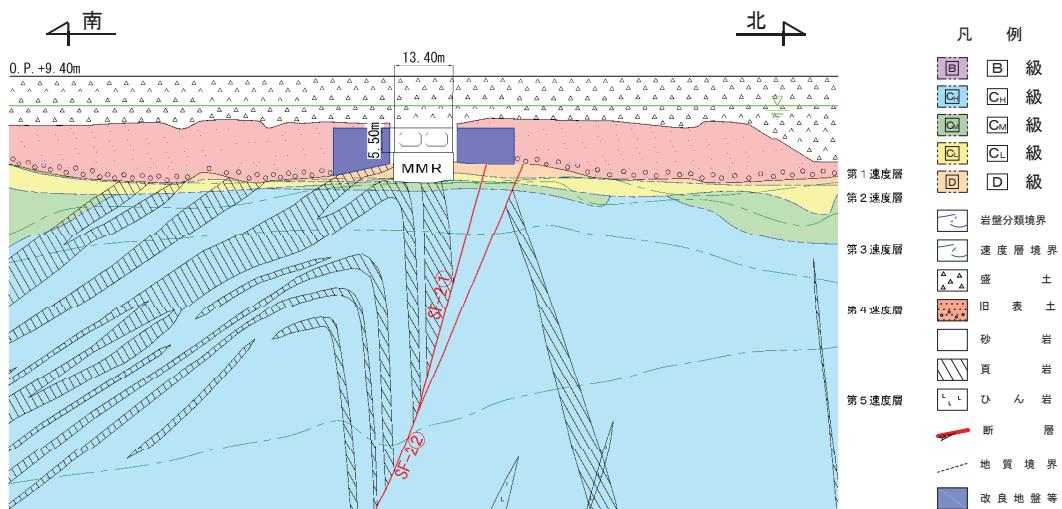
(2) 取水路（標準部） 地震時荷重算出断面図（断面③：直線部）
